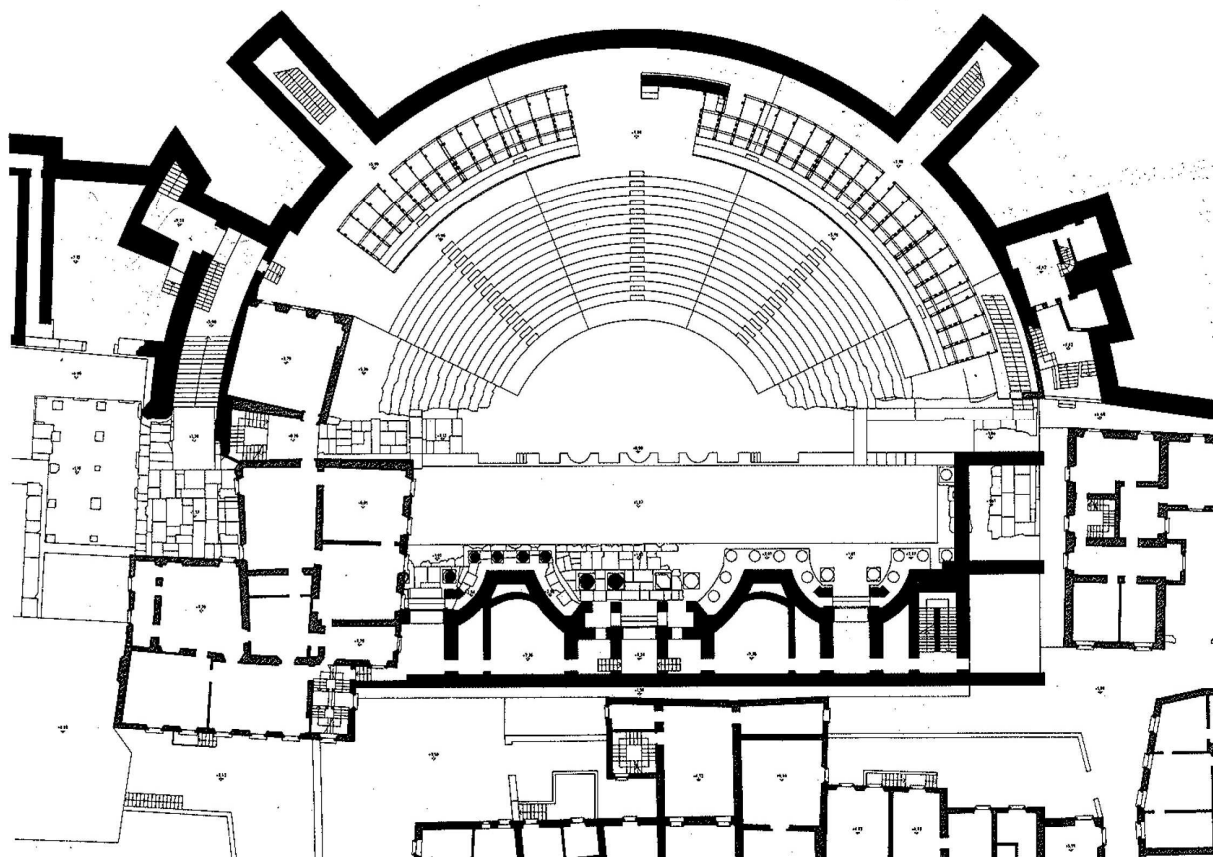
Pianta del progetto di Giorgio Grassi- pianta a quota +8.90
